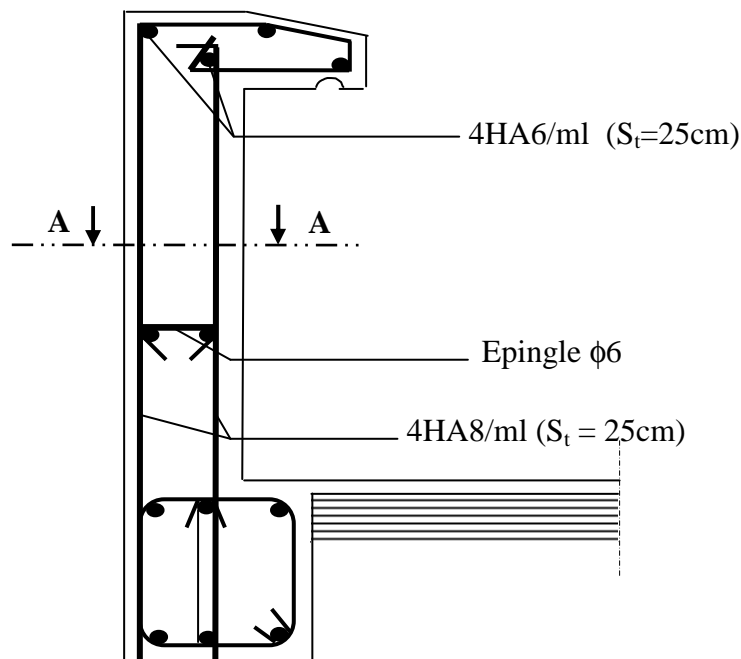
Plan de ferrailage de l'acrotère
